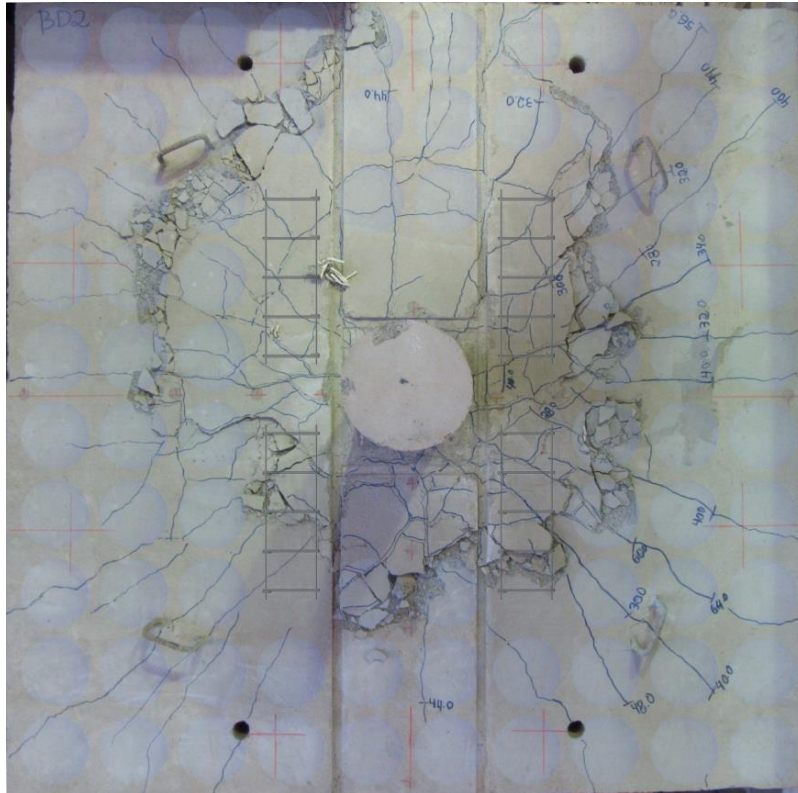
Mapa de fissuração da laje BD2
